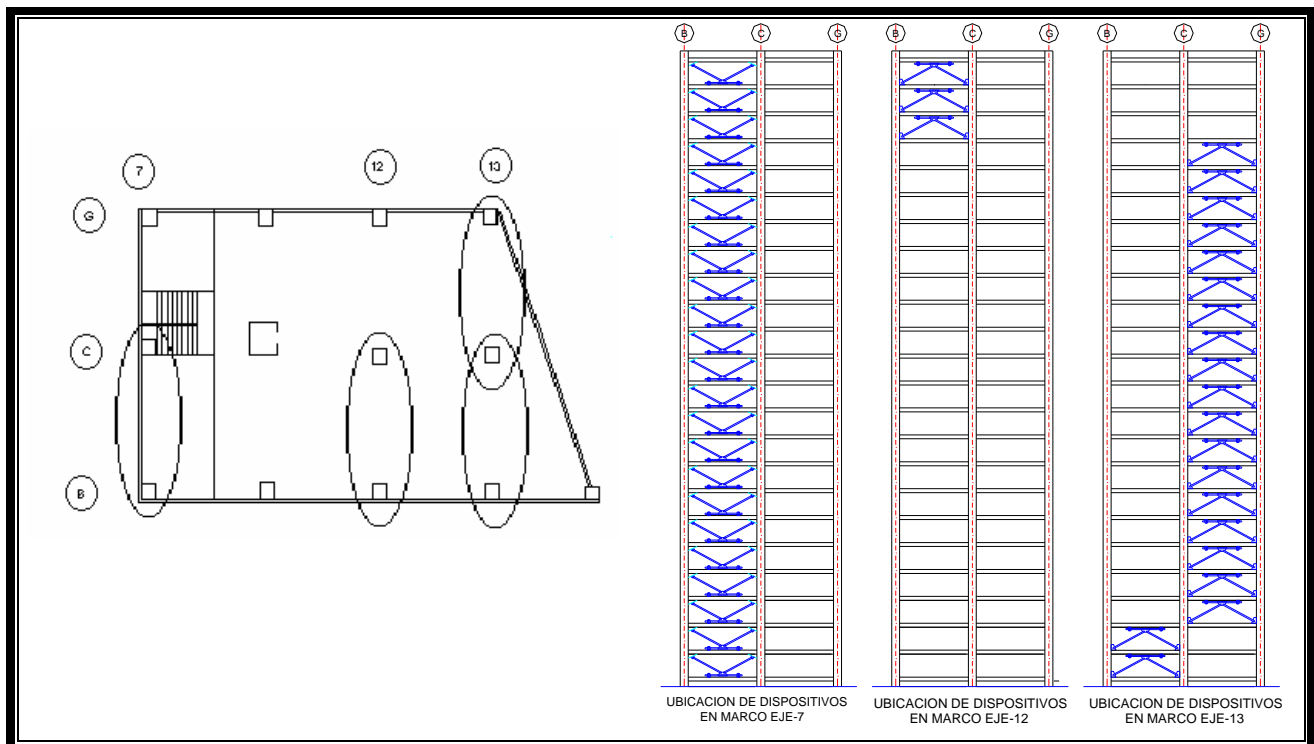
Distribución en planta y elevación de los disipadores de energía.
